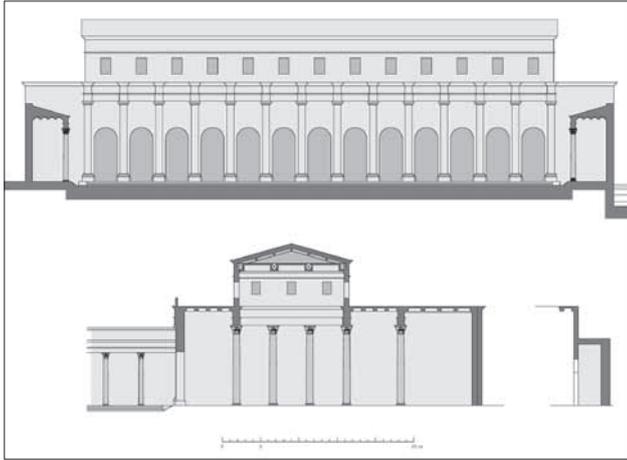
Restitución de la fachada de la basílica jurídica hacia la plaza forense y sección transversal por el eje axial. La presencia de bloques de pilastras entre las ruinas del edificio permite plantear que la fachada tuviera un sistema de puertas y no una doble columnata.
